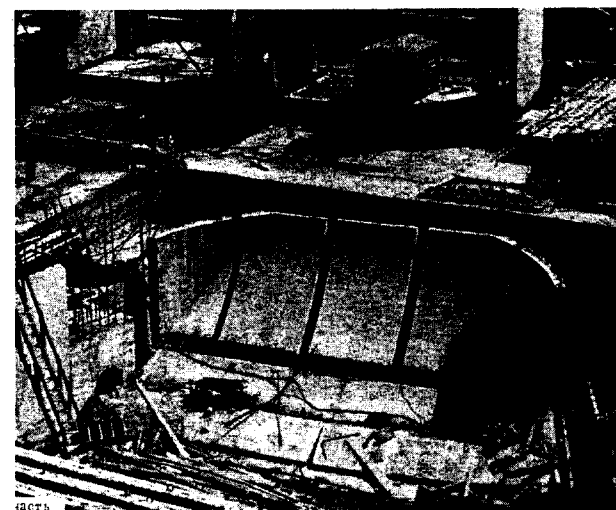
Опалубка из железобетонных скорлуп на пяте отсасывающей трубы Рижской ГЭС
